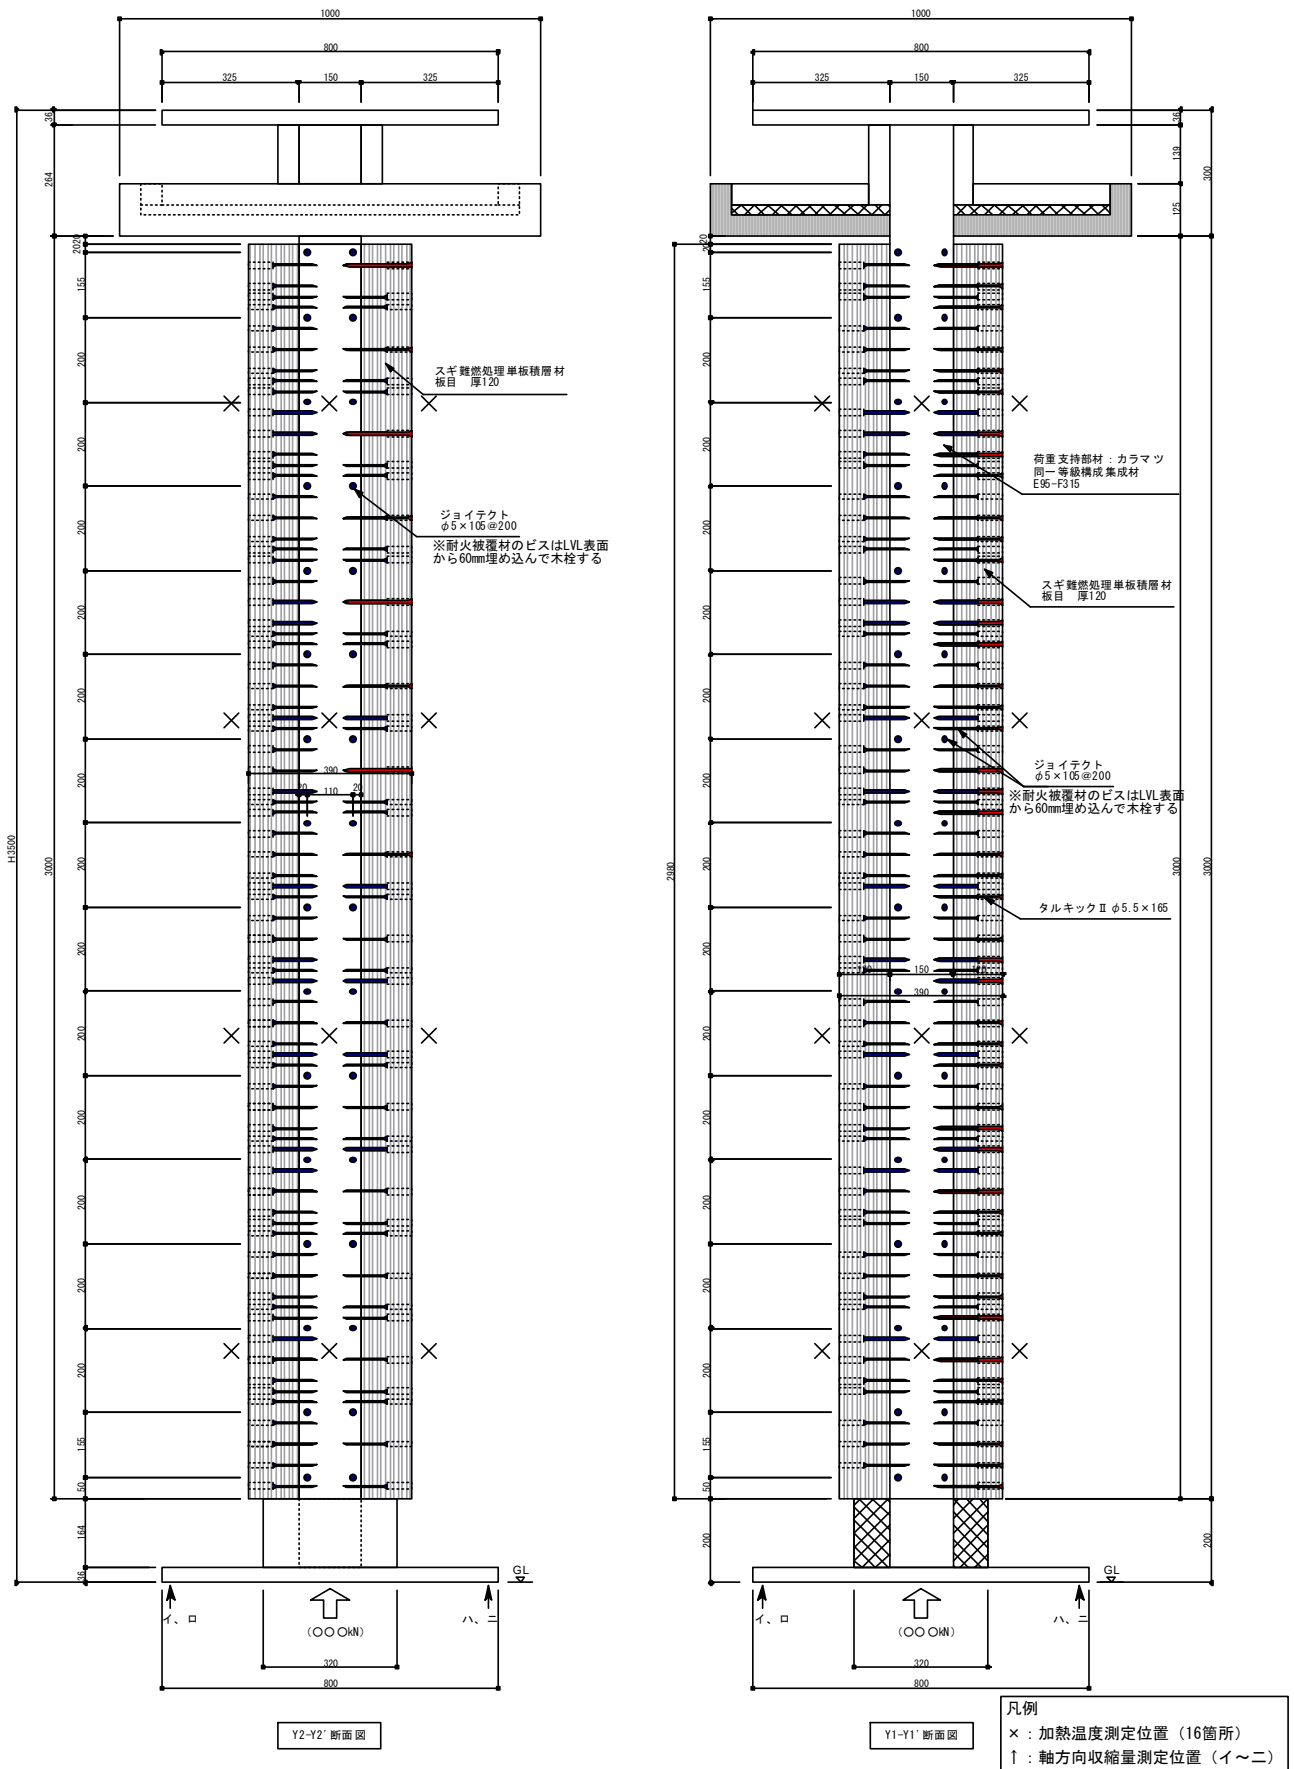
試験体の構造・寸法・温度測定位置 (Y 通り)
